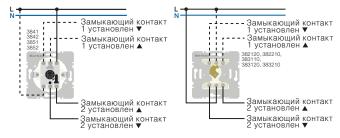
Поворотный выключатель жалюзи 1- и 2-полюсный [№ для заказа 3841, 3842]; выключатель жалюзи 1- и 2-полюсный для центральной панели с замком [№ для заказа 3851, 3852]/выключатель/кнопка жалюзи 1- и 2-полюсный для профильных полуцилиндров [№ для заказа 382... 383..]
